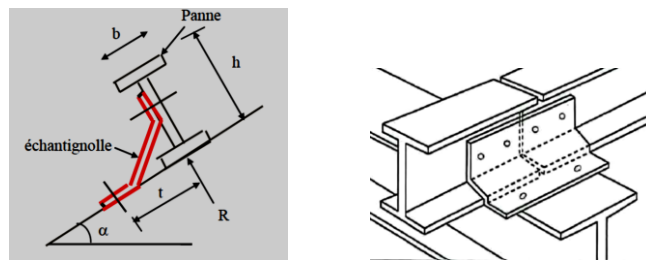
détails de disposition de l'échantignolle sur poutre traverse de portique
